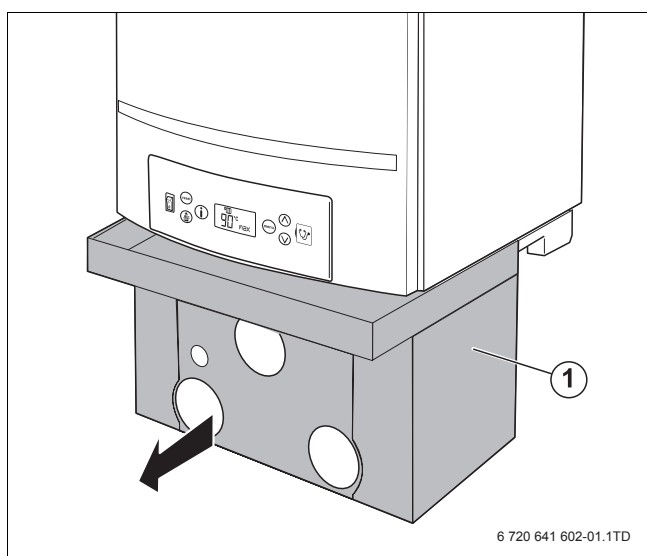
Rivestimento del gruppo di collegamento (accessorio)
